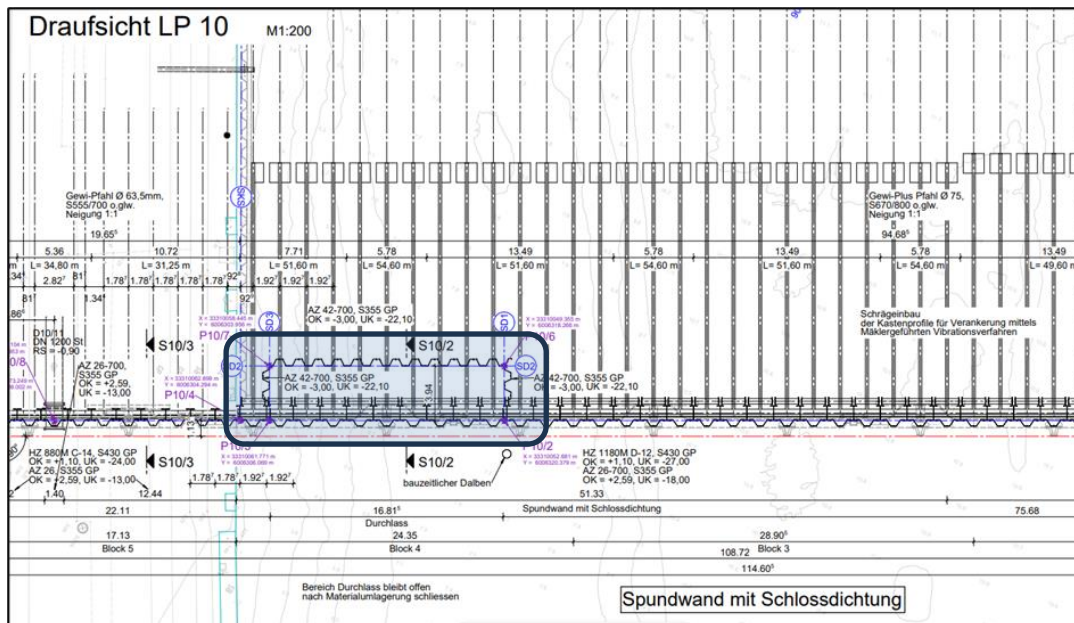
Auszug Konstruktionsplan Liegeplatz P10 mit Darstellung der bauzeitlichen Durchfahrtsöffnung
